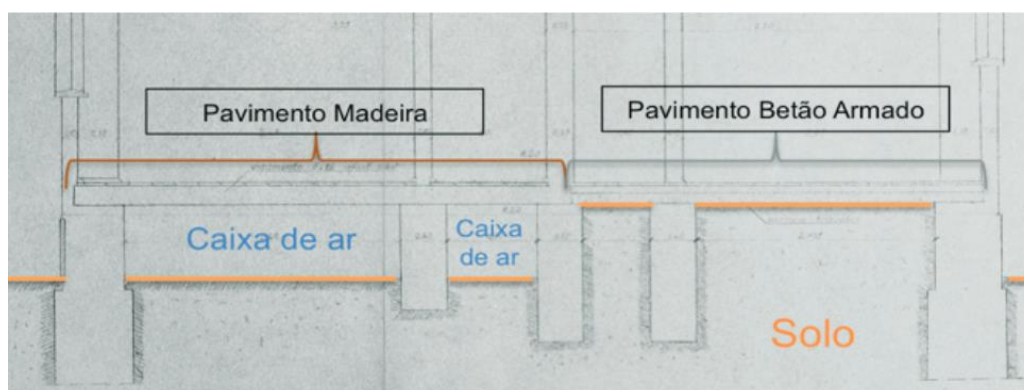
Pavimento de madeira e de betão armada (Fonte: [144]).
